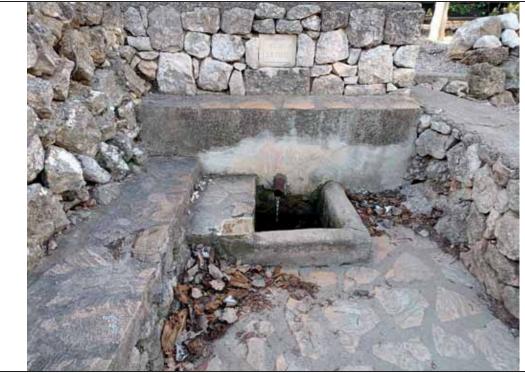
Frontal y banco de fuente. Se proyecta el chapado del frontal y ampliación de bancada lateral.
